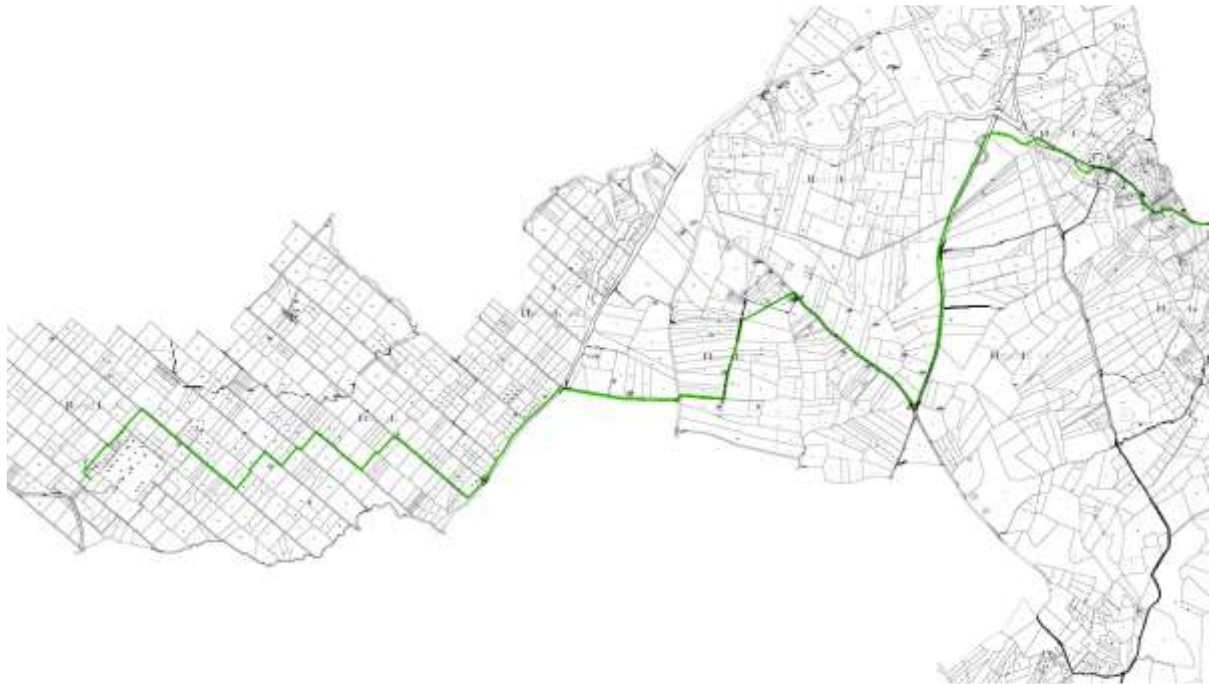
Rappresentazione generale del cavidotto (1/4)
